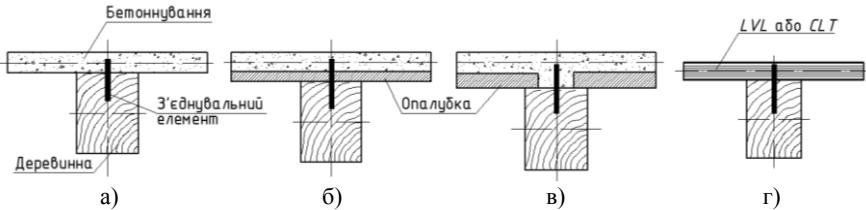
Типові поперечні перерізи дерев'яно-бетонних композитних плит
